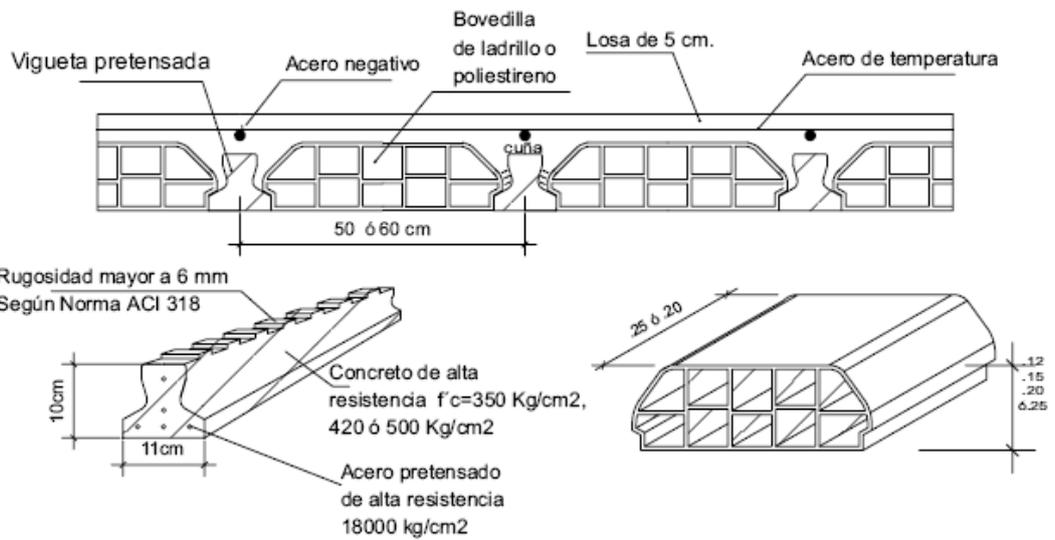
Losa aligerada con viguetas pretensadas.
